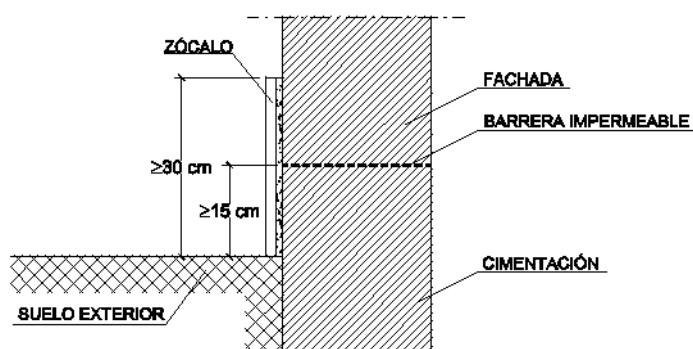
Ejemplo de arranque de la fachada desde la cimentación
